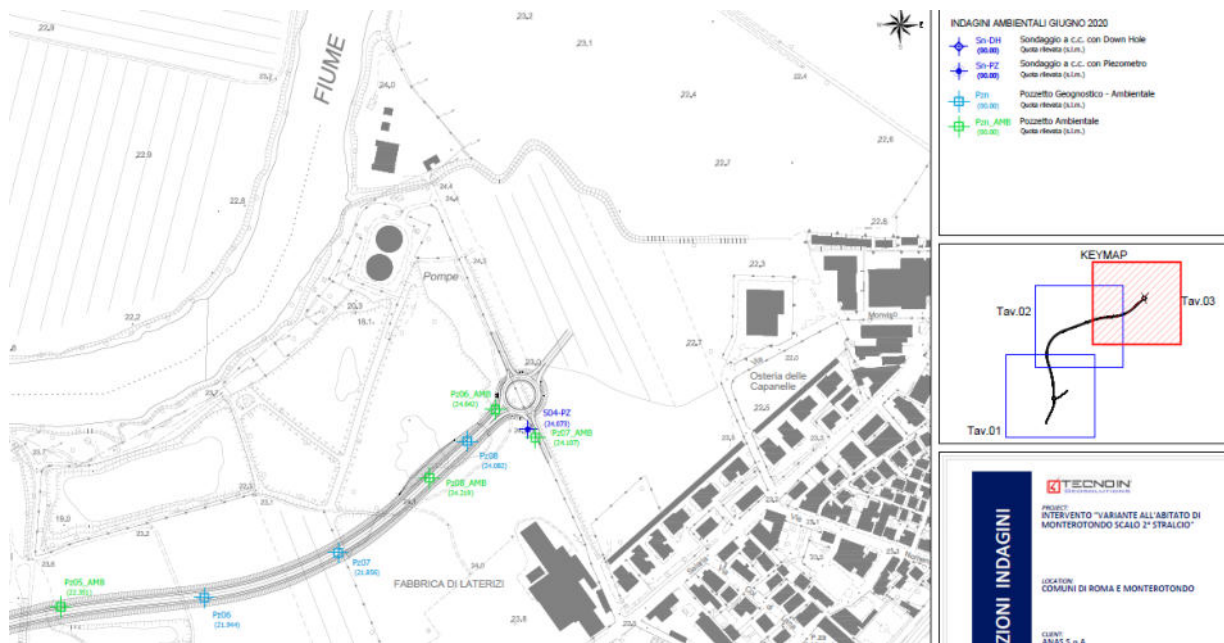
Planimetria con individuazione dei sondaggi/pozzetti.
